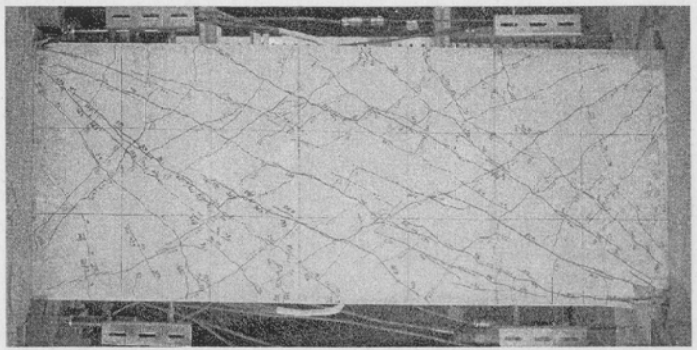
通常のコンクリート。数は少ないがひび割れの幅が大きい
